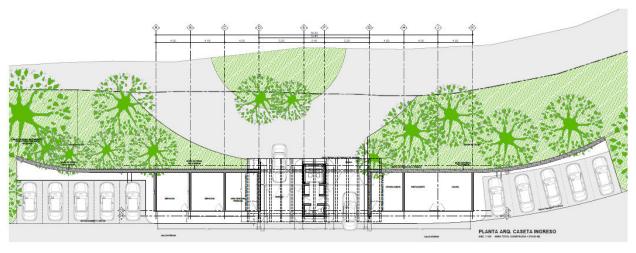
Planta arquitectónica de la caseta de ingreso al desarrollo del Proyecto
